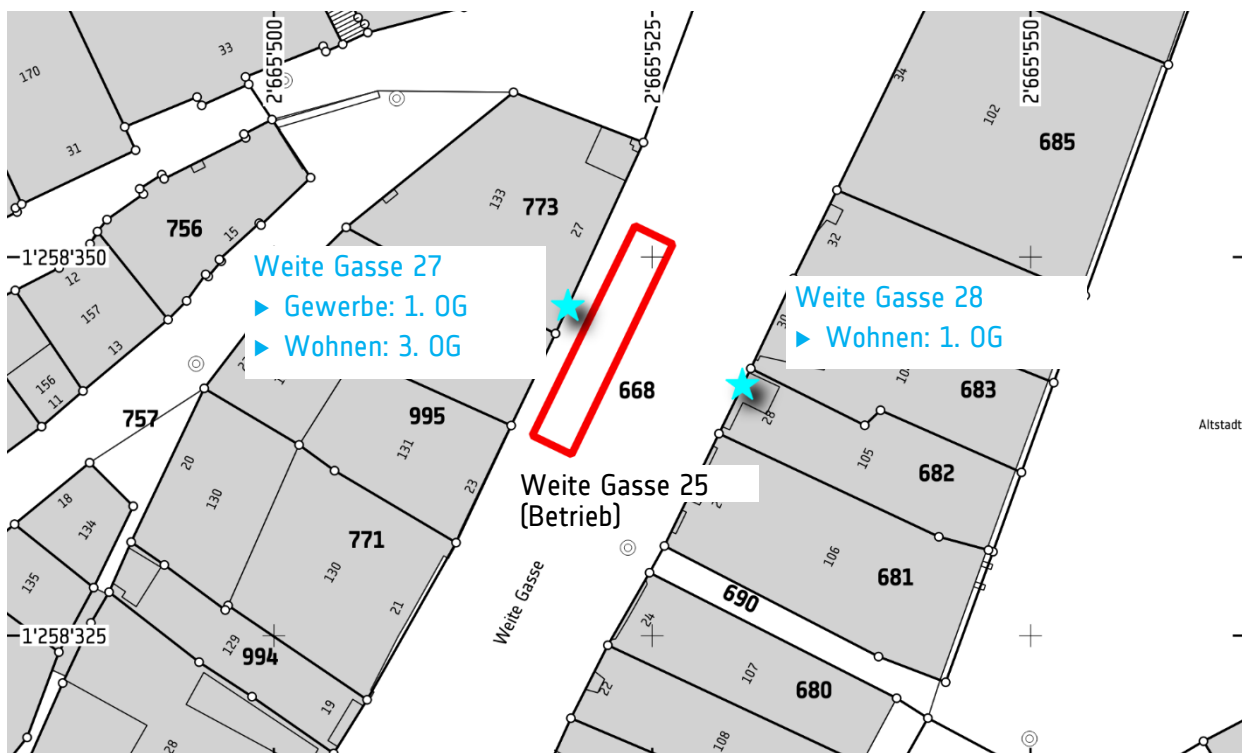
Situationsplan 1:500 mit Lage des geplanten Boulevardcafés (rot) sowie mit Immissionsorten (blaue Sterne).
